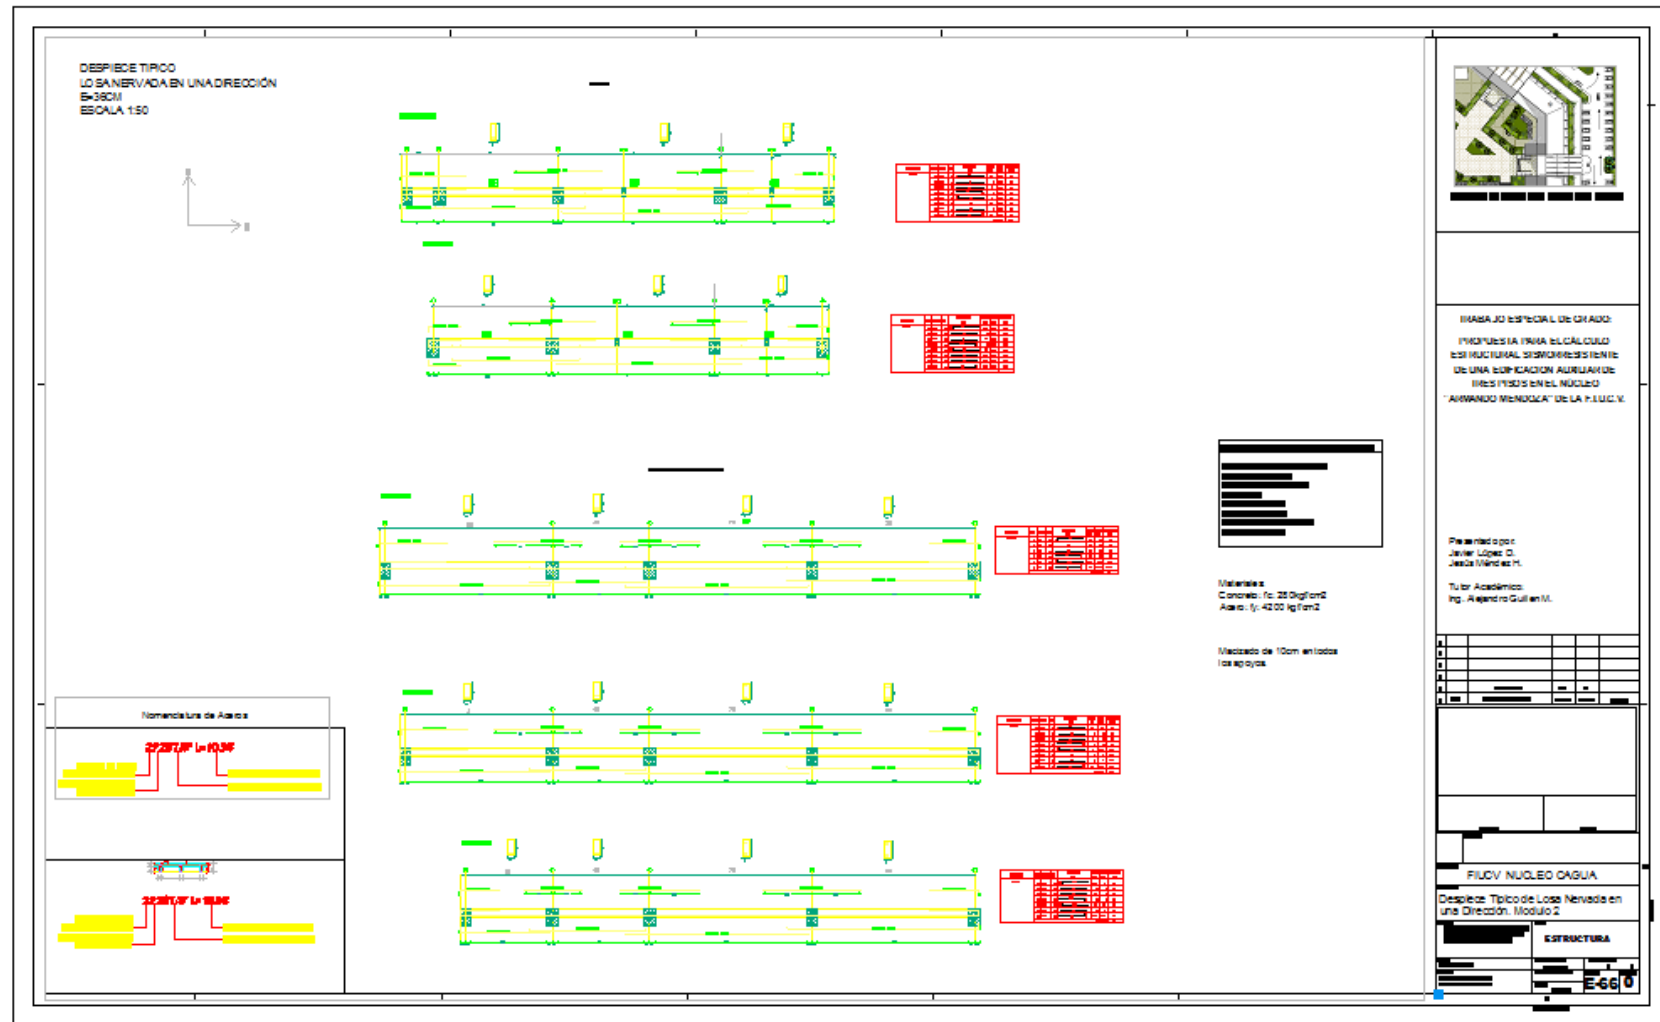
Ejemplo Plano de detalle de Viga. Edificio Módulo 2.
